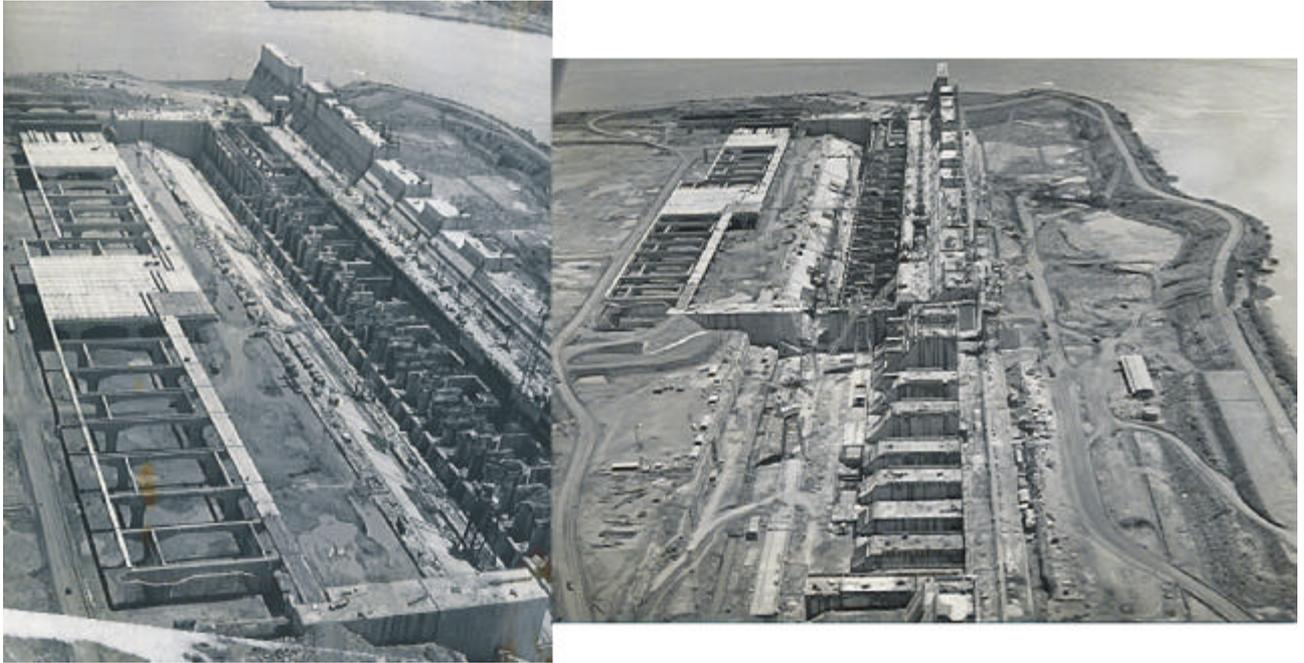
Concreto de Face (estrutura em concreto Massa Convencional) -Ilha Solteira
